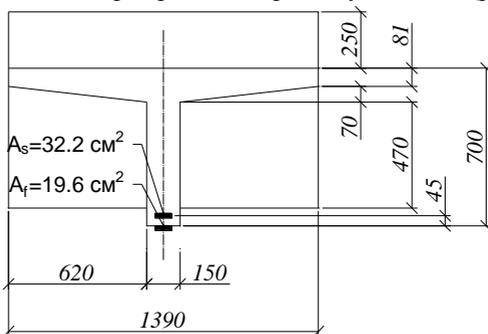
Сечение балки по типовому проекту СДП выпуск 56, усиленной накладной плитой и дополнительным внешним армированием растянутой зоны
